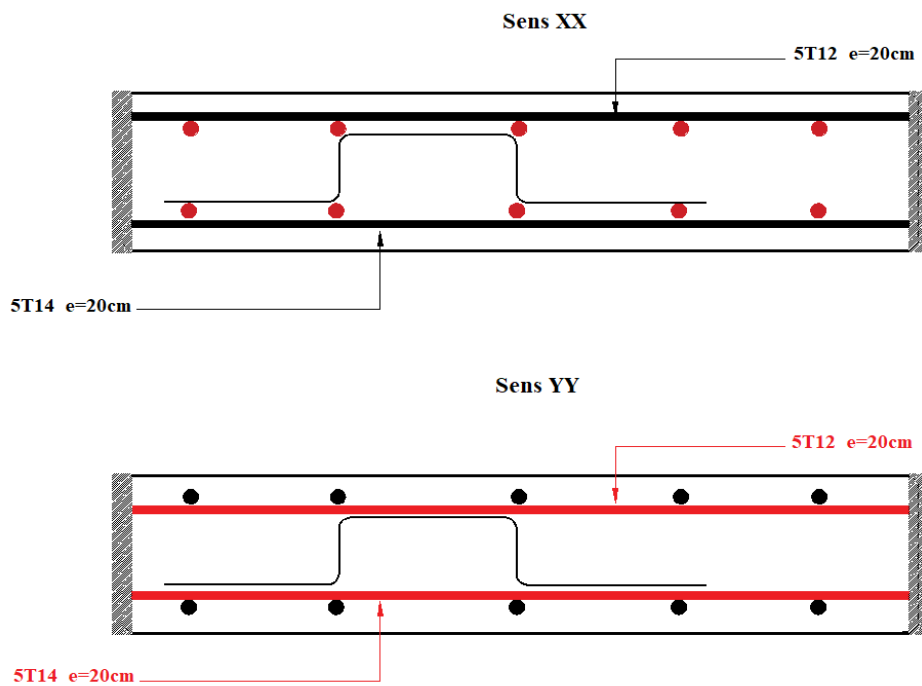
Coupes transversales de ferrailage de la dalle de Sous-Sol.
